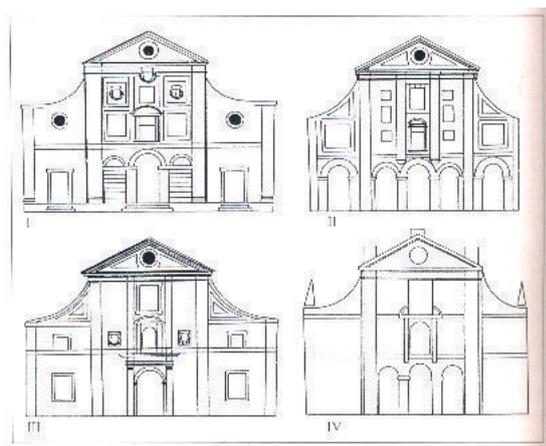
„Vignoleske Kirchenfassade“ nach Sturm.
